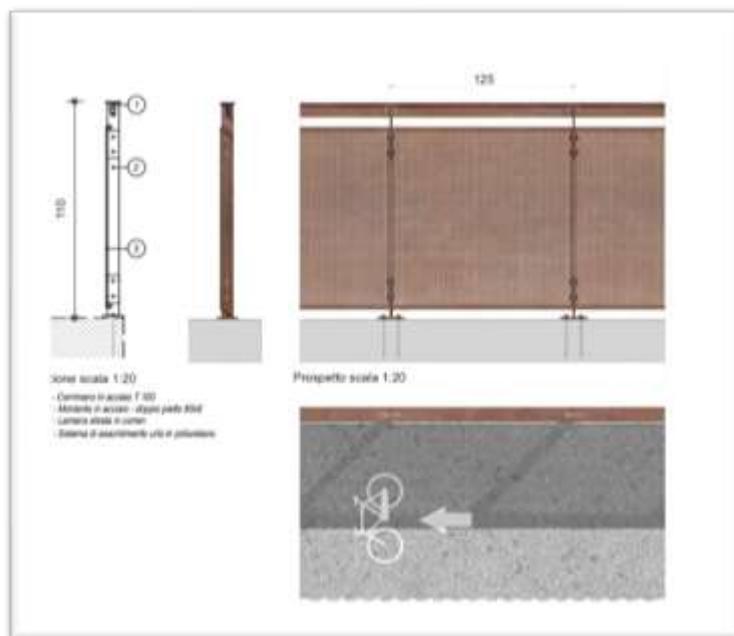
Parapetti tipo VENTO, da progetto MATE
